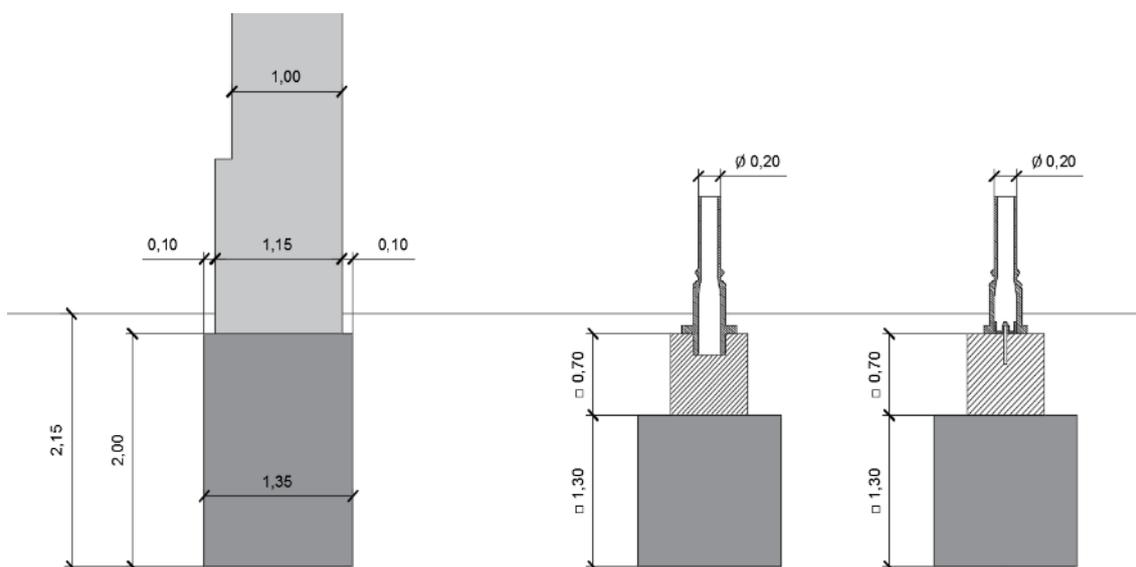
Sección zapatas, A. Bajo muro; B. Posibles soluciones de zapata bajo pilares.
